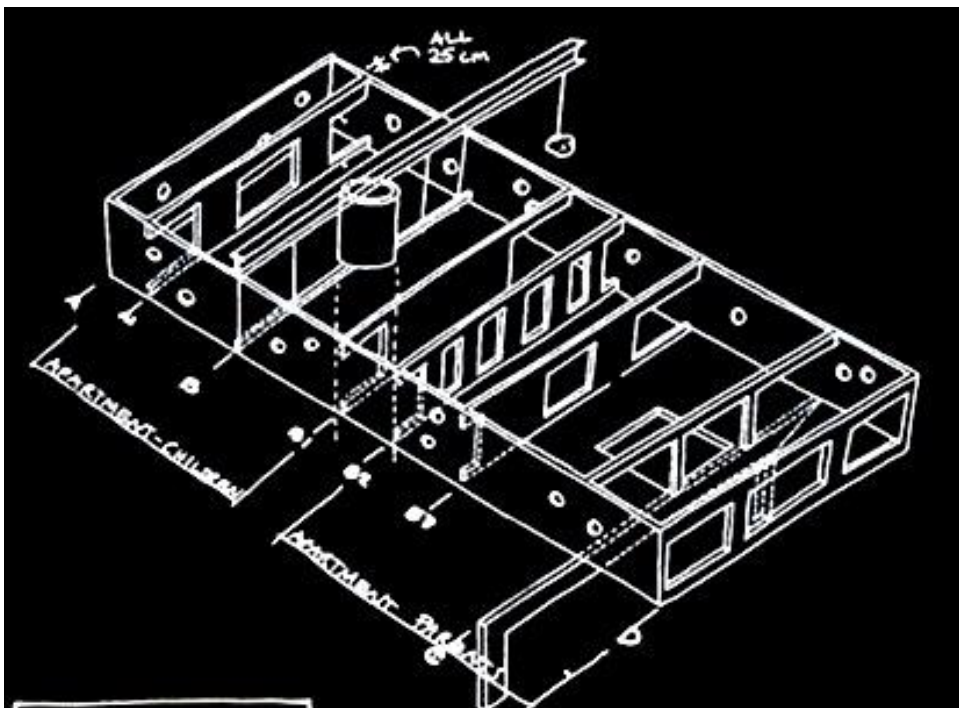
Sistema estrutural completo da casa Bordeaux. Cecil Balmond
